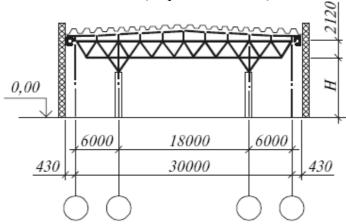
Каркас здания из конструкций типа "Кисловодск"
